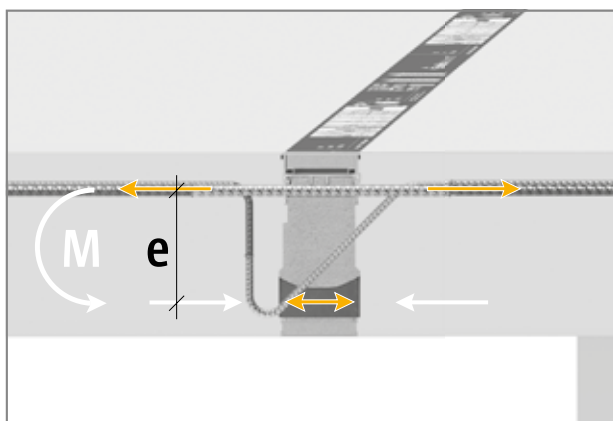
Schöck Isokorb® typ K: Nepřímé uložení balkónu
